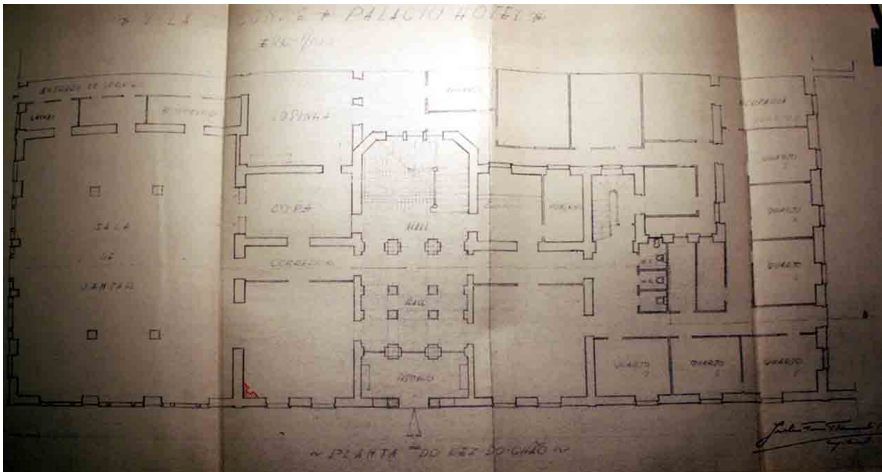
Plan parteru w Palácio Hotel de Vila do Conde w roku 1946. Archiwum Miejskie w Vila do Conde.
